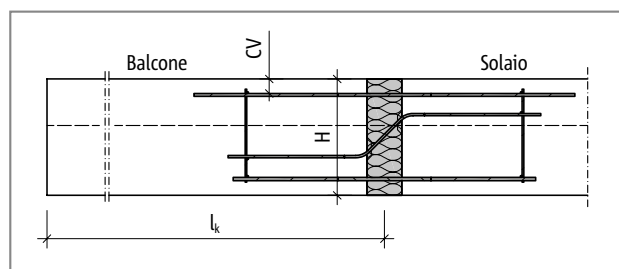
Schöck Isokorb® tipo SXT: sistema statico
